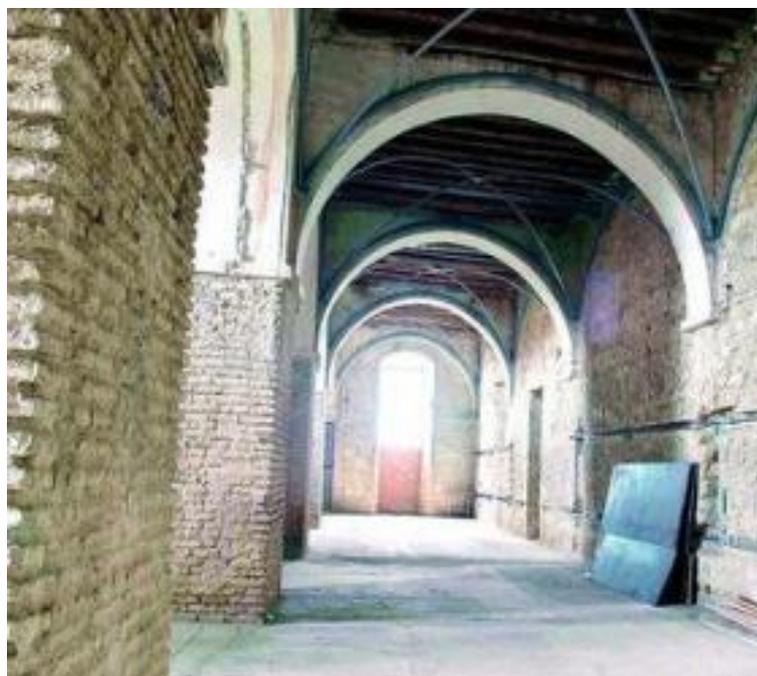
Instalación de cerchas para construcción de bóvedas de crucería²¹⁶
